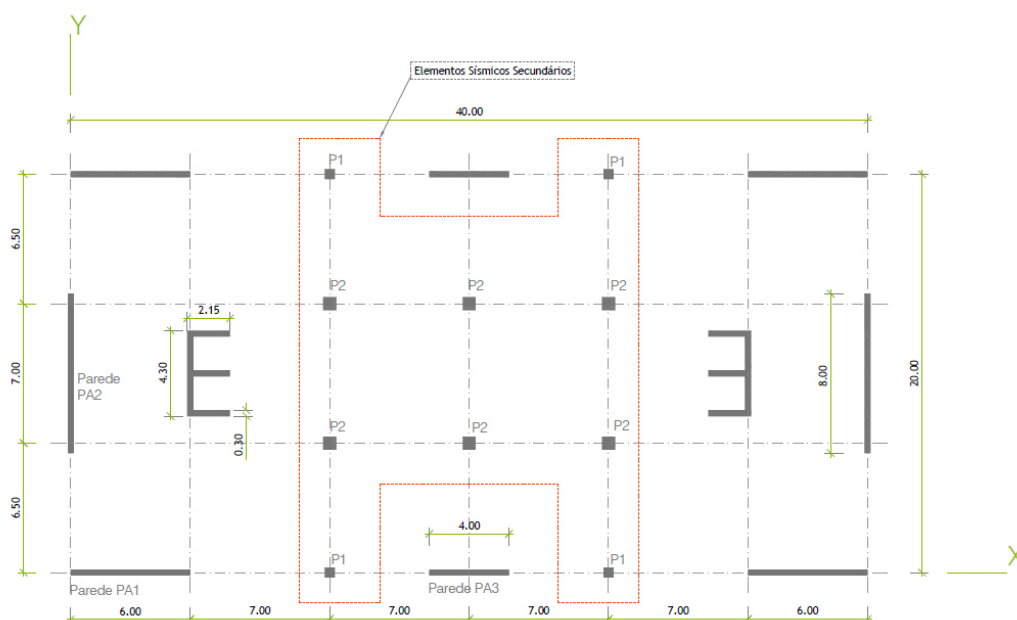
Planta estrutural do edifício idealizado, com a identificação dos elementos secundários
